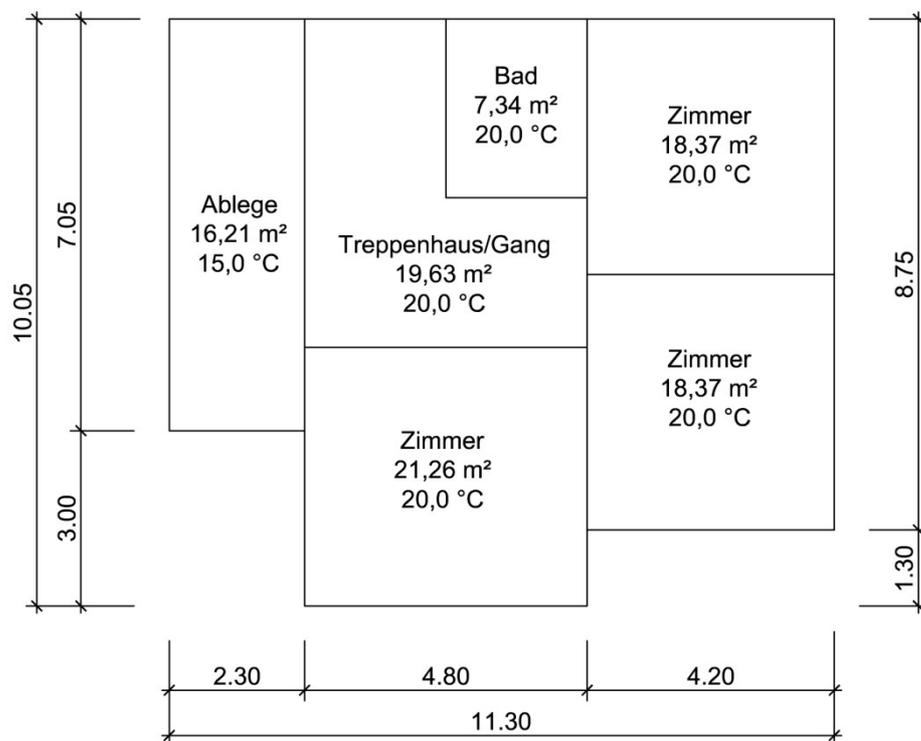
Grundriss: konditioniertes Obergeschoss
